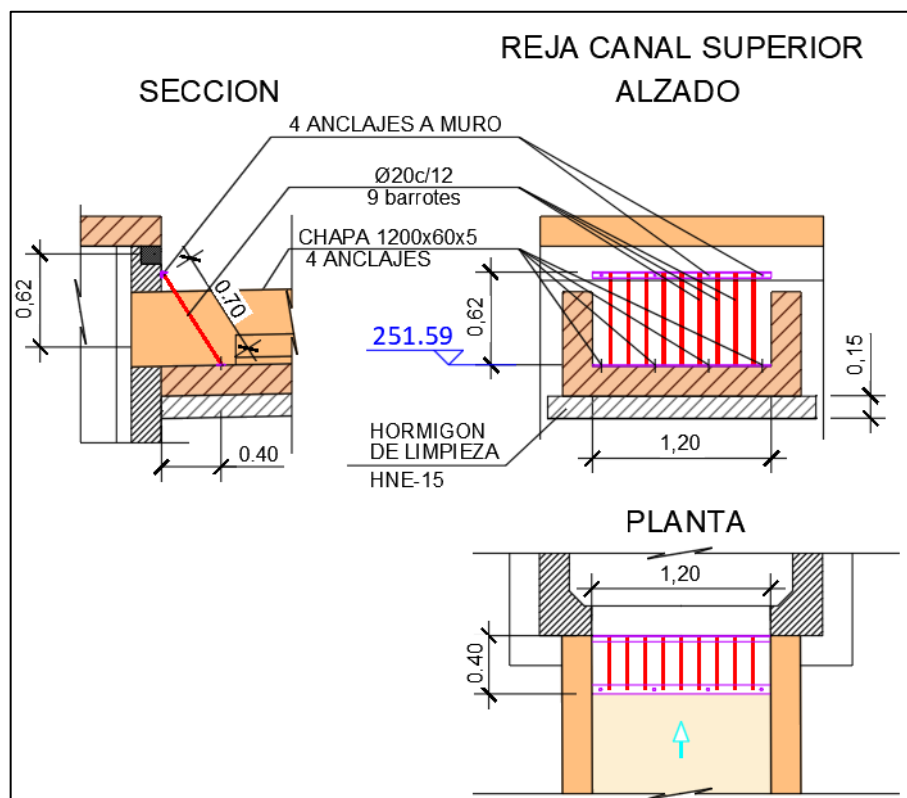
Reja de la arqueta/pozo prefabricado que recoge los caudales del canal de las salidas de pluviales del cementerio de Torrero.
